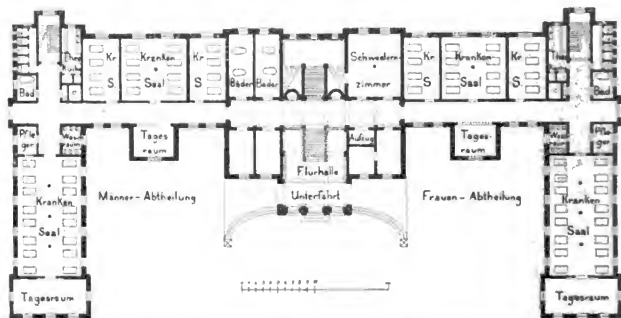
Grundriß des Chirurgischen Krankenhauses.
